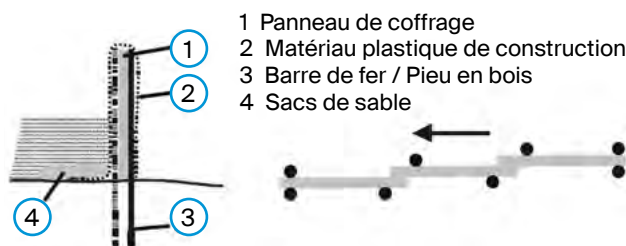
Section transversale et vue d'un système de panneaux (AEAI)
